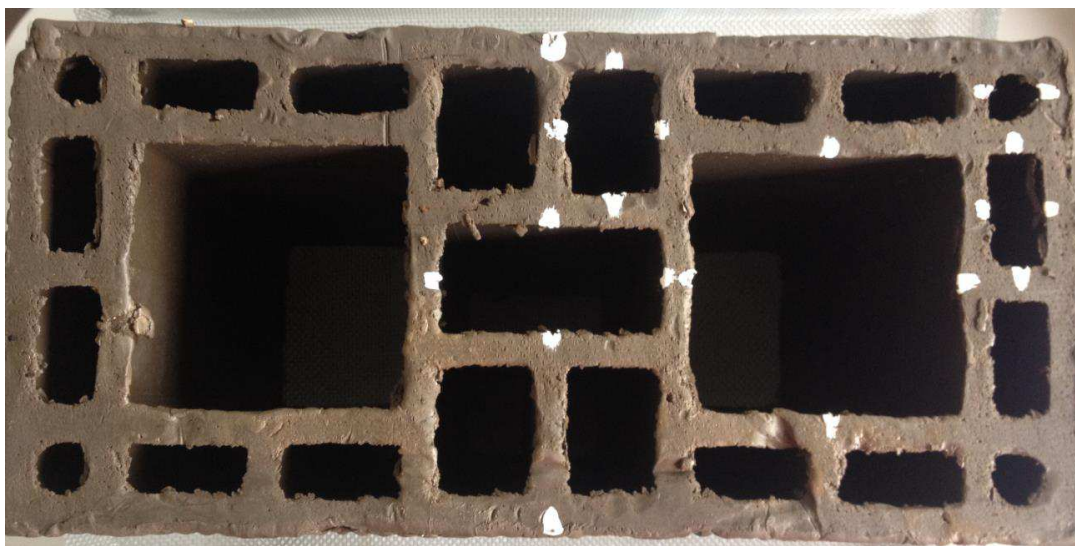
Vista superior do bloco de vedação utilizado no experimento.
